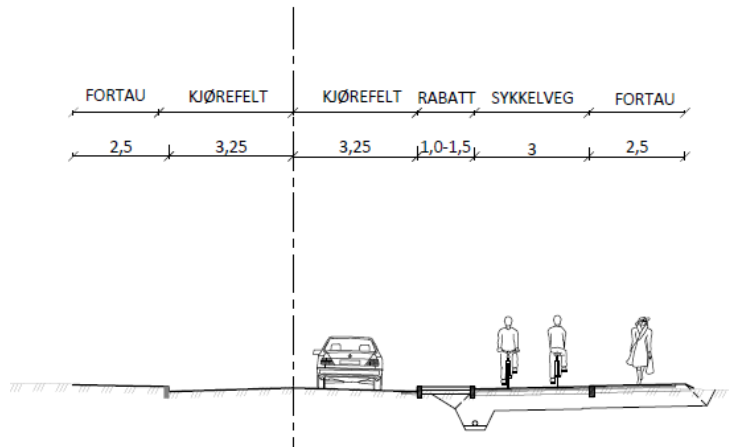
Tilpasset løsning langs strekningen. Dagens trerekke langs Gamle Oslovei 12-26 erstattes med nye trær i en bred trafikddeler
